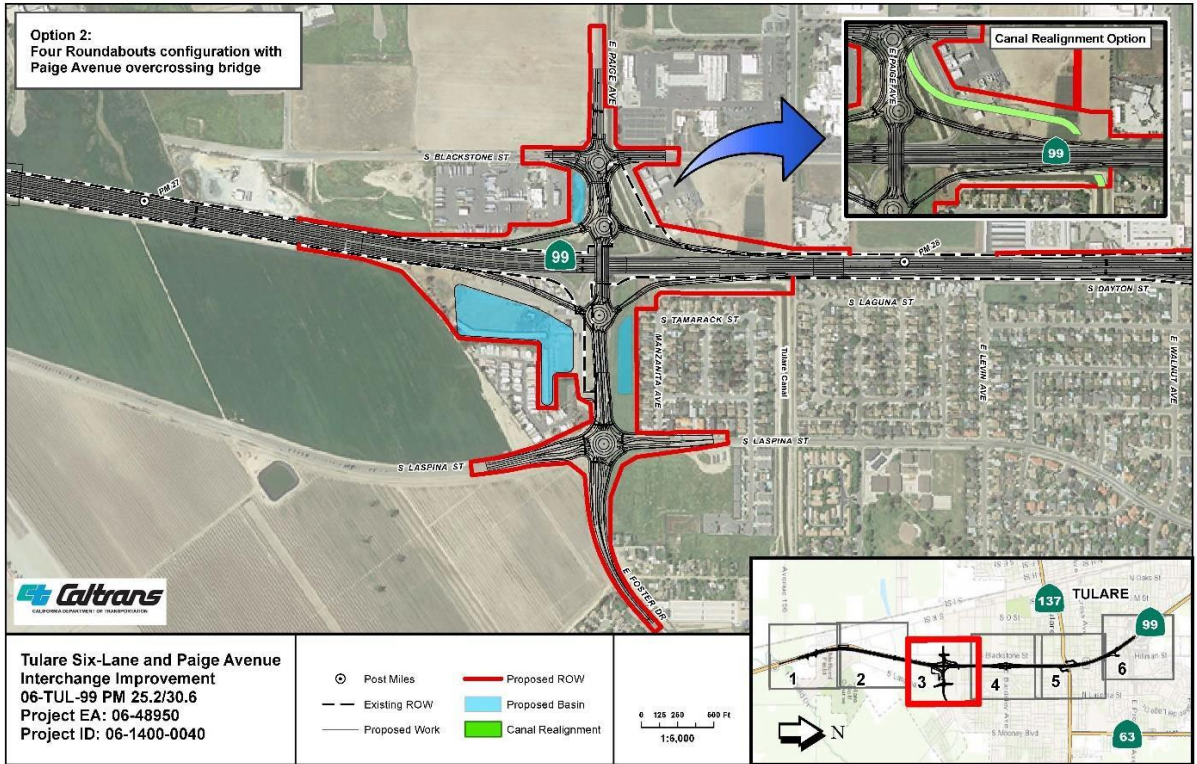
Plano de diseño 4 (intercambio de Paige Avenue): Opción 2 Configuración de cuatro rotondas con puente de cruce subterráneo de Paige Avenue
